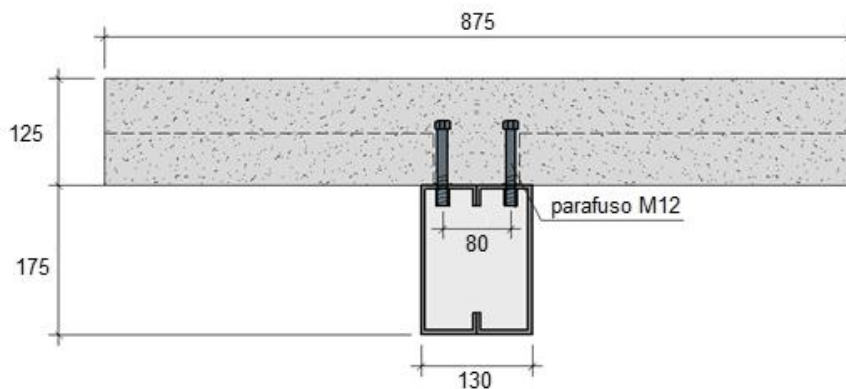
Seção transversal de uma viga mista (Oliveira, 2009).
